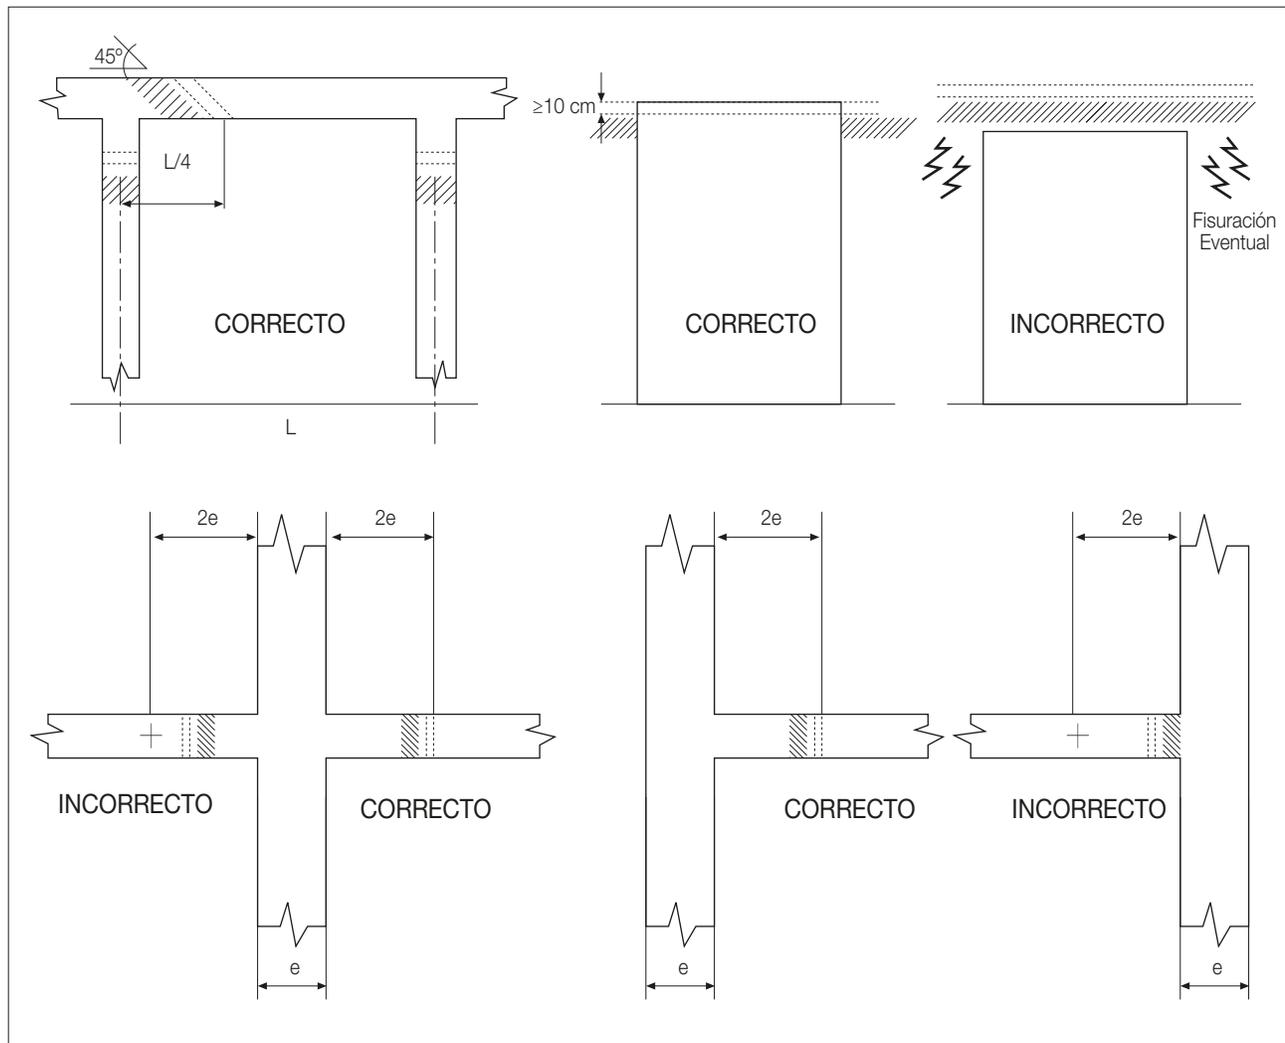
Ubicación de las Juntas de Hormigonado Losas y Vigas, Vanos de Muros y Cruces y Encuentros de Vigas
